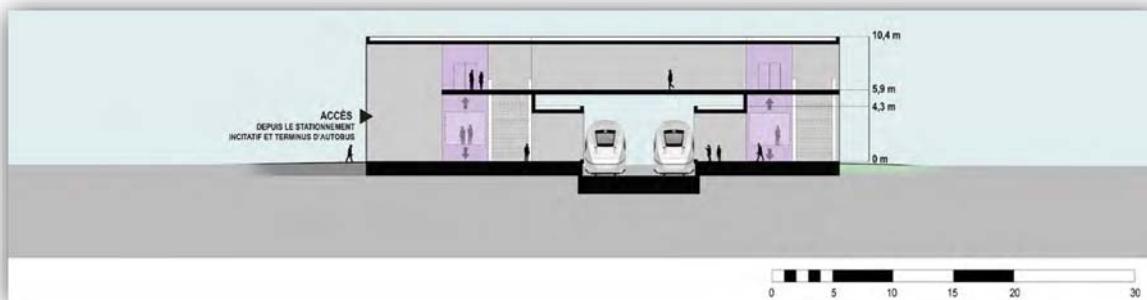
Coupe transversale de la station terminale Rive-Sud
